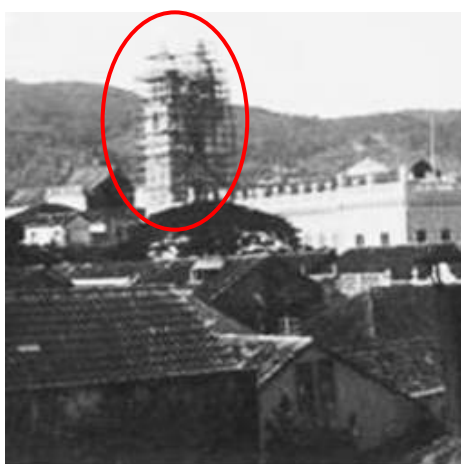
Obras de elevação e reforço das torres da Catedral – 1922
